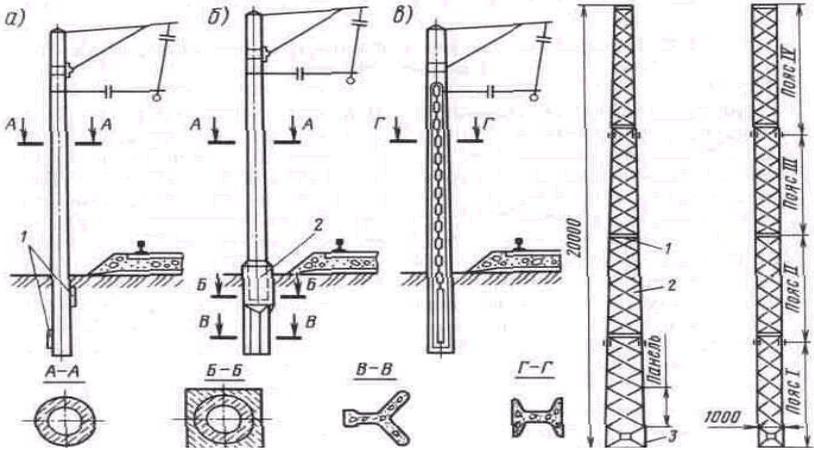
Железобетонные опоры: при установке консольных конических опор, устанавливаемых без фундаментов (а),– применяют лежни 1. Такие опоры устанавливают на фундаментах стаканного типа (б). Двухъяровые опоры (в) устанавливают без фундаментов
